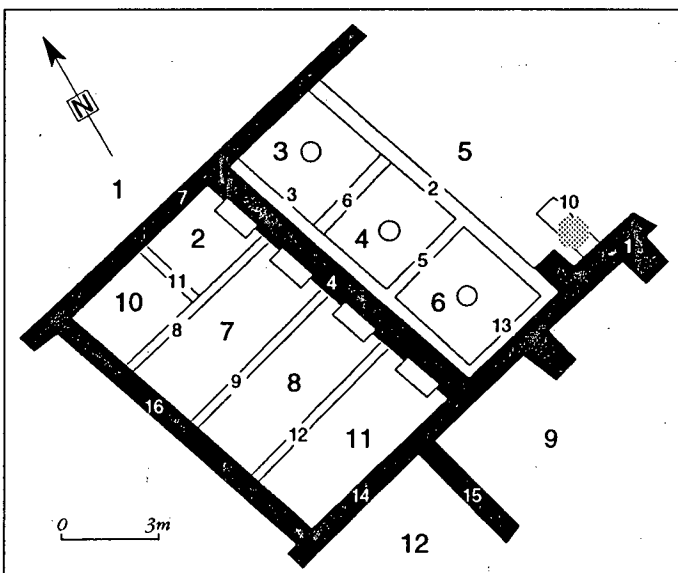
CAVALAIRE, Rue du Port. Plan schématique de la villa.
